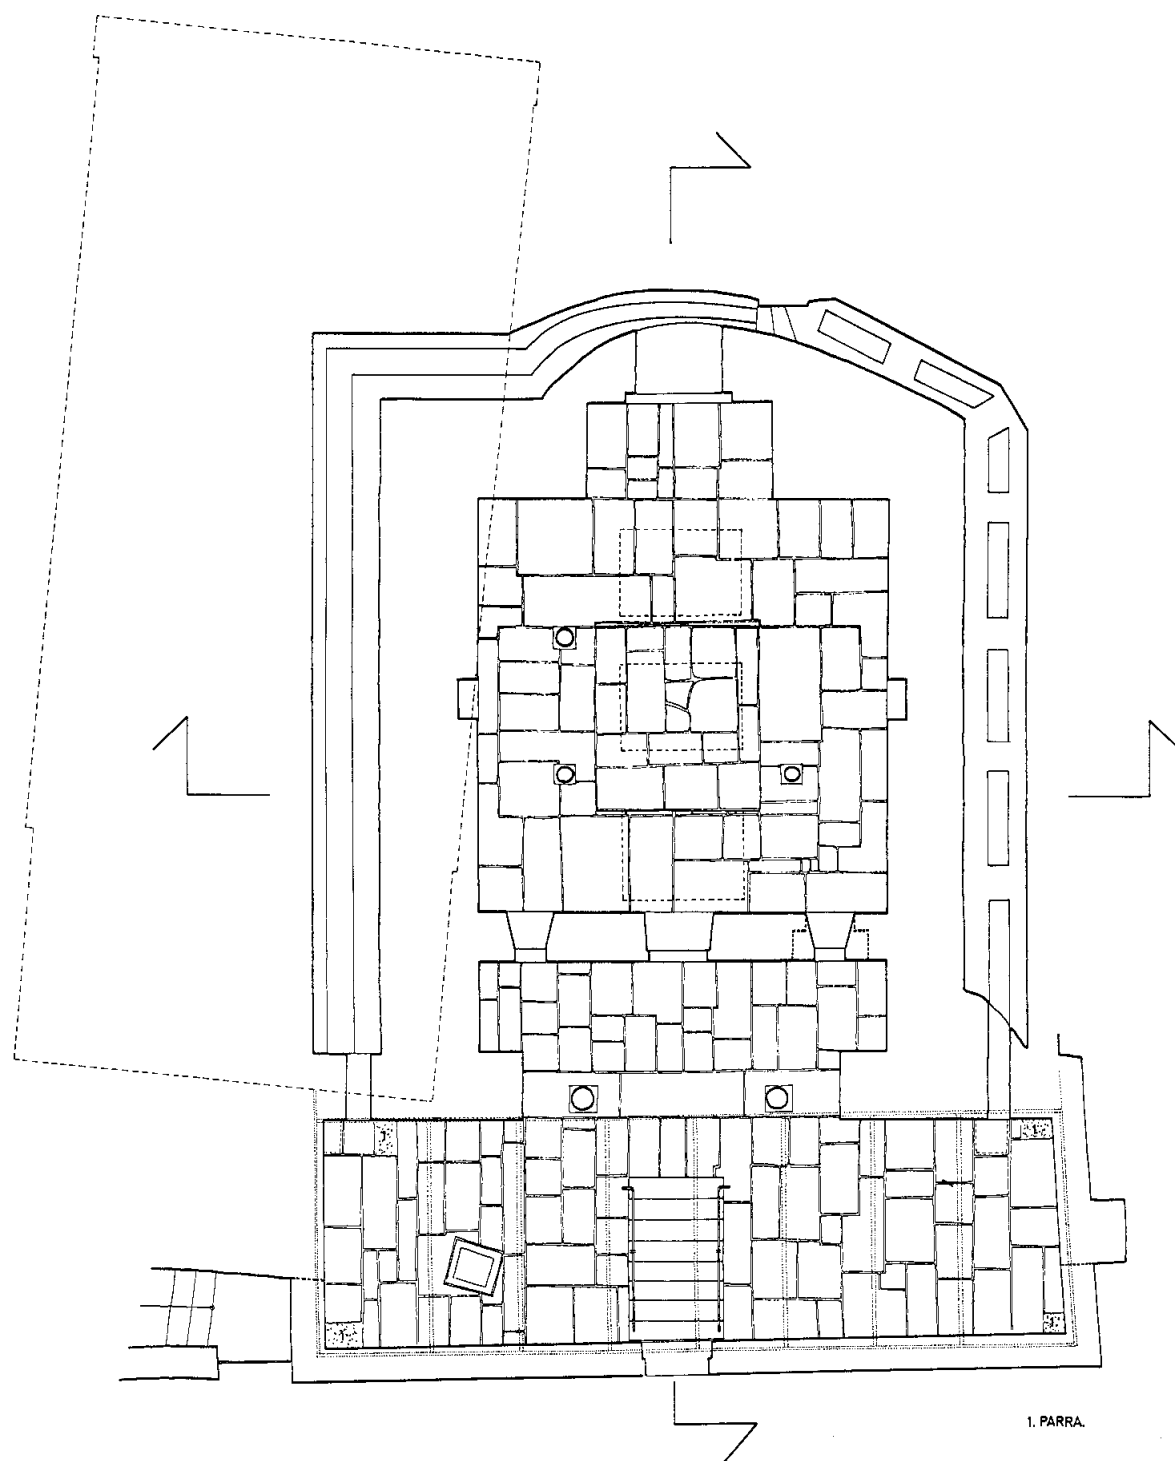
Santa Eulalia de Bóveda. Planta con detalle del enlosado del pavimento indicando las áreas restauradas.
